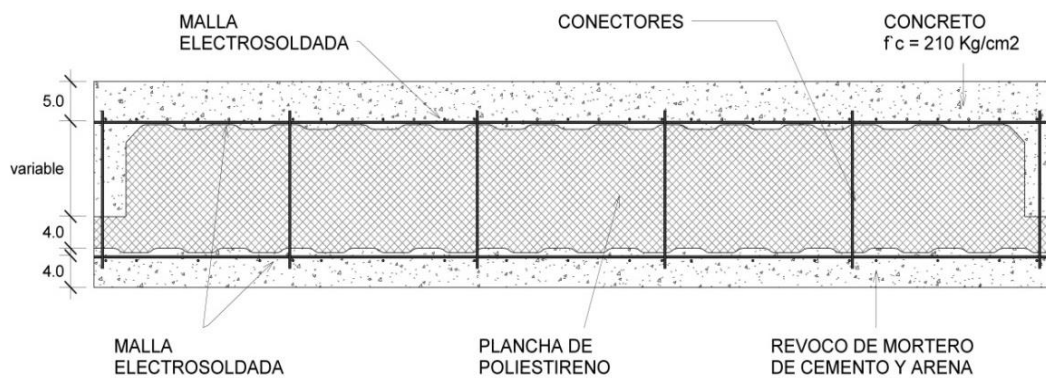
Panel forjado con nervadura para armado de viga PL1
